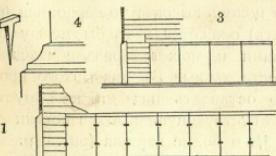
Кордонные облицовки простынного вида: 1) фасадъ и угол облицовки покоятъ плитами, удерживаемыми гвоздями; 2) видъ гвоздя; 3) откладка покоятъ плитами и однимъ покосомъ; 4) деталь штукатурного сандыка.
